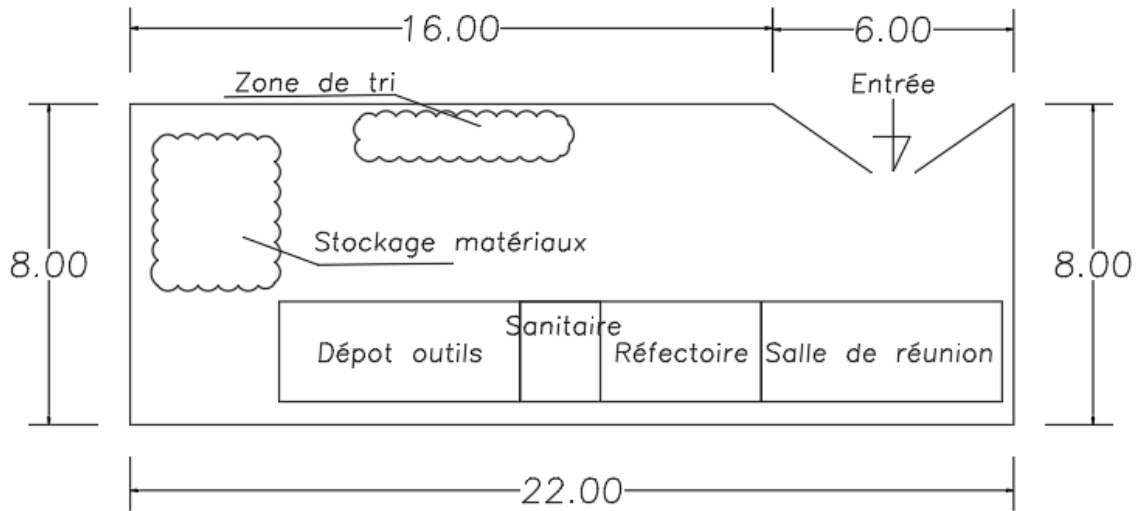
Schéma de l'installation de chantier (Source : Guez Caraïbe)
